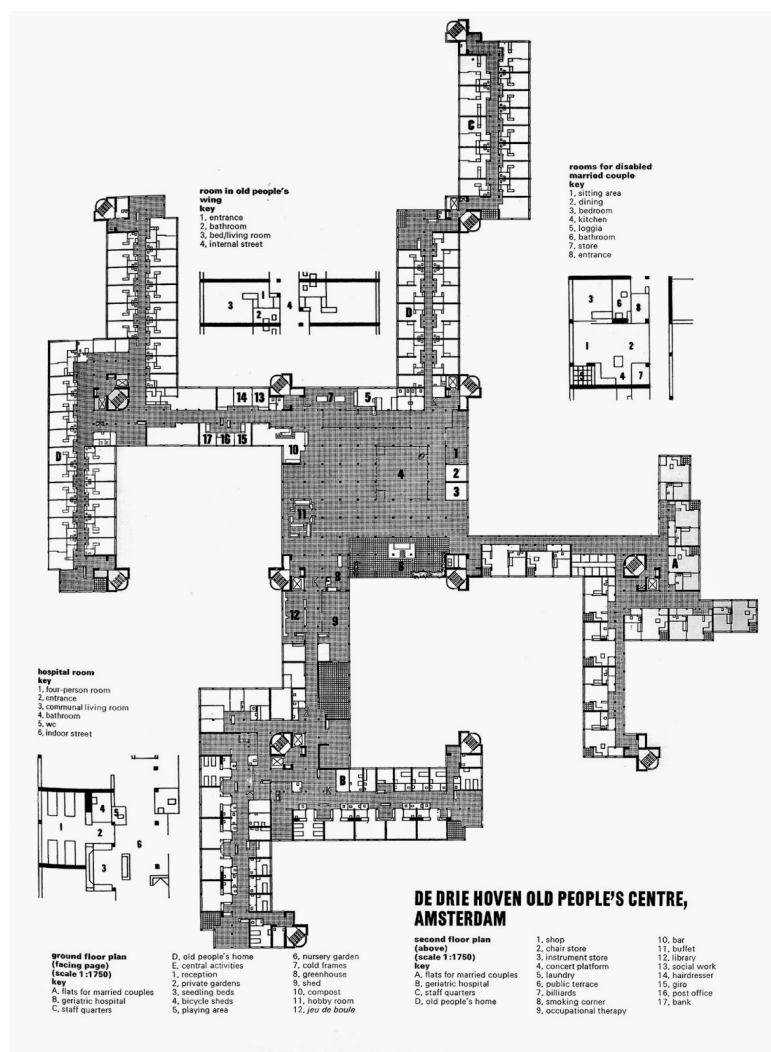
Plano de planta baja. Fuente: Urbipedia.org
